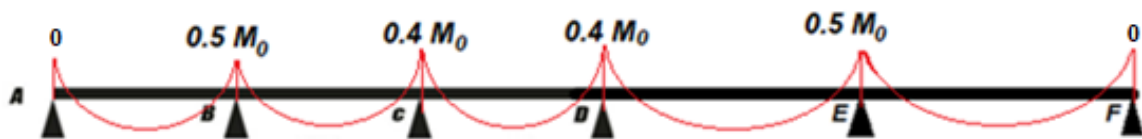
Schéma du 1^{eme} type de poutrelle.
